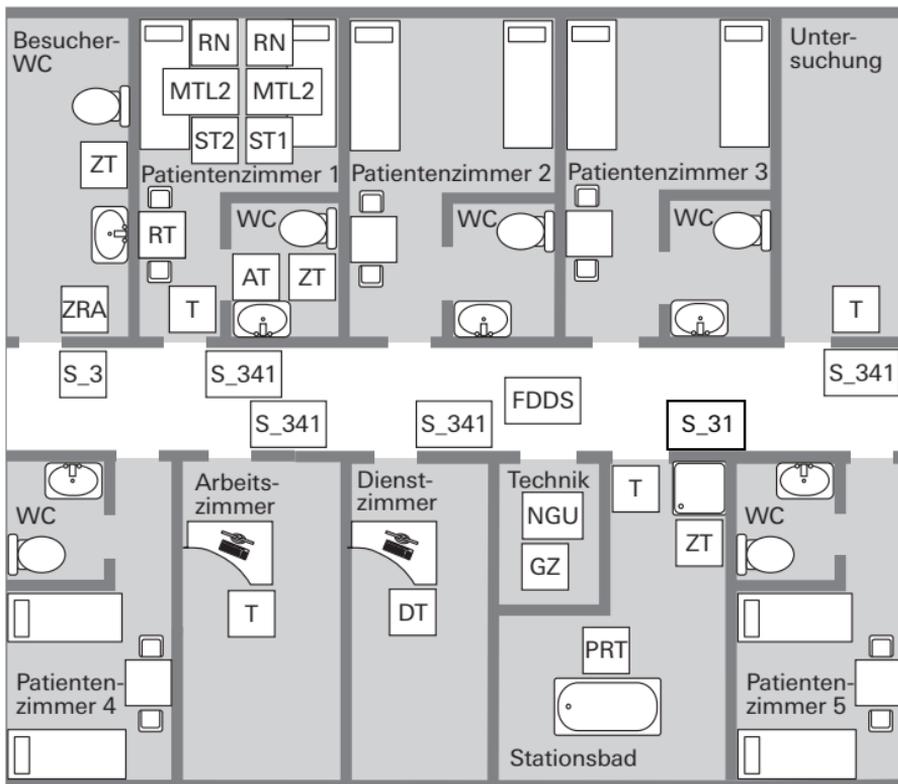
Installationsbeispiel für das Gira Rufsystem 834 in einem Krankenhaus
